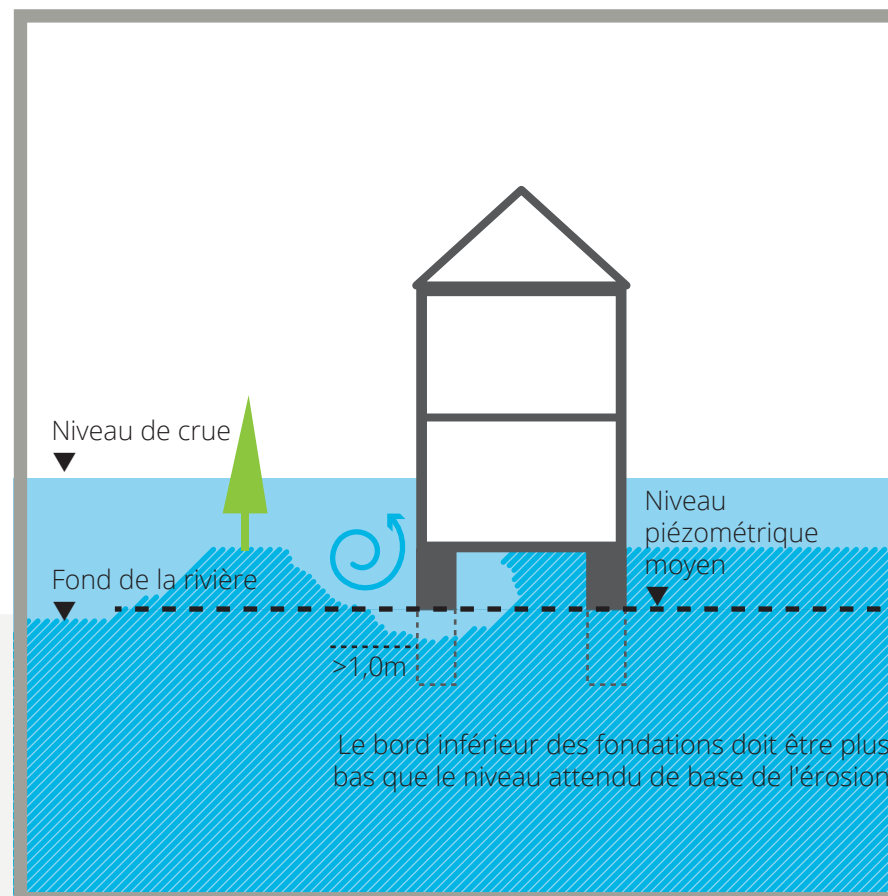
Fondations déchaussées (phénomène d'affouillement) (DWA-M 553)
